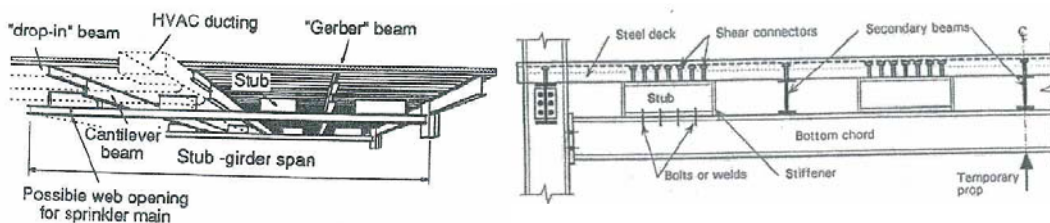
Forjados mixtos con el sistema *stub girder*.
